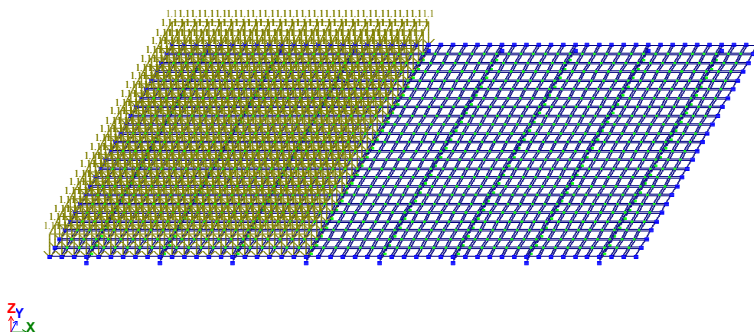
Временная нагрузка на плиту перекрытия в крайней части.
